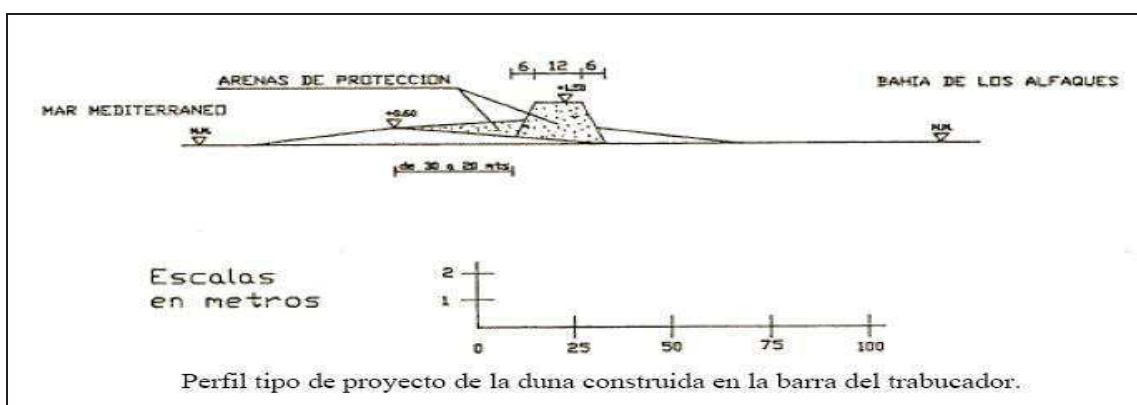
Perfil tipo de duna en la barra del Trabucador.
